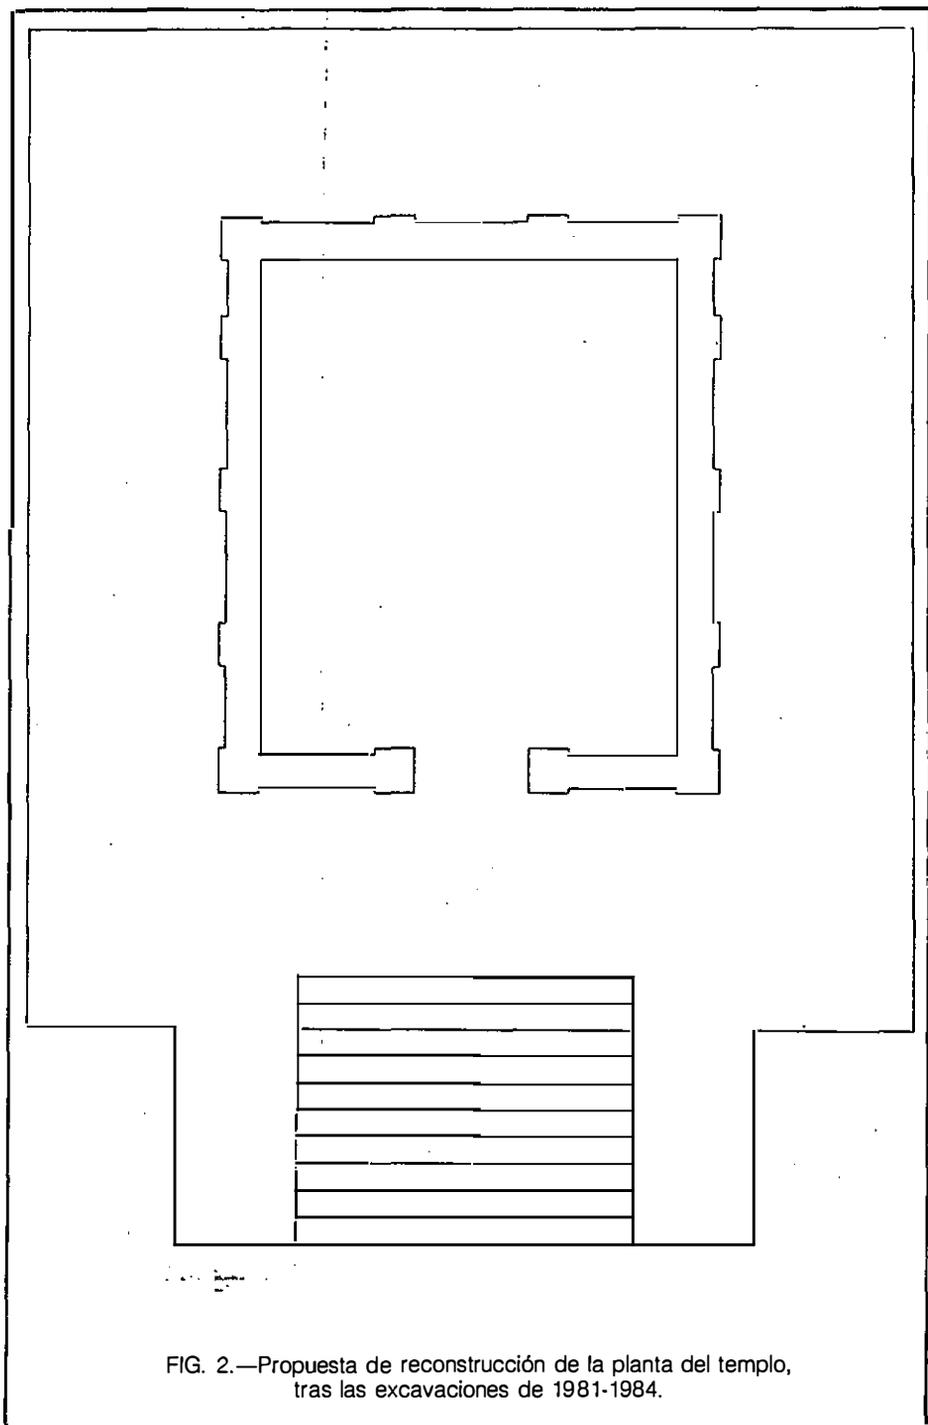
Propuesta de reconstrucción de la planta del templo, tras las excavaciones de 1981-1984.
